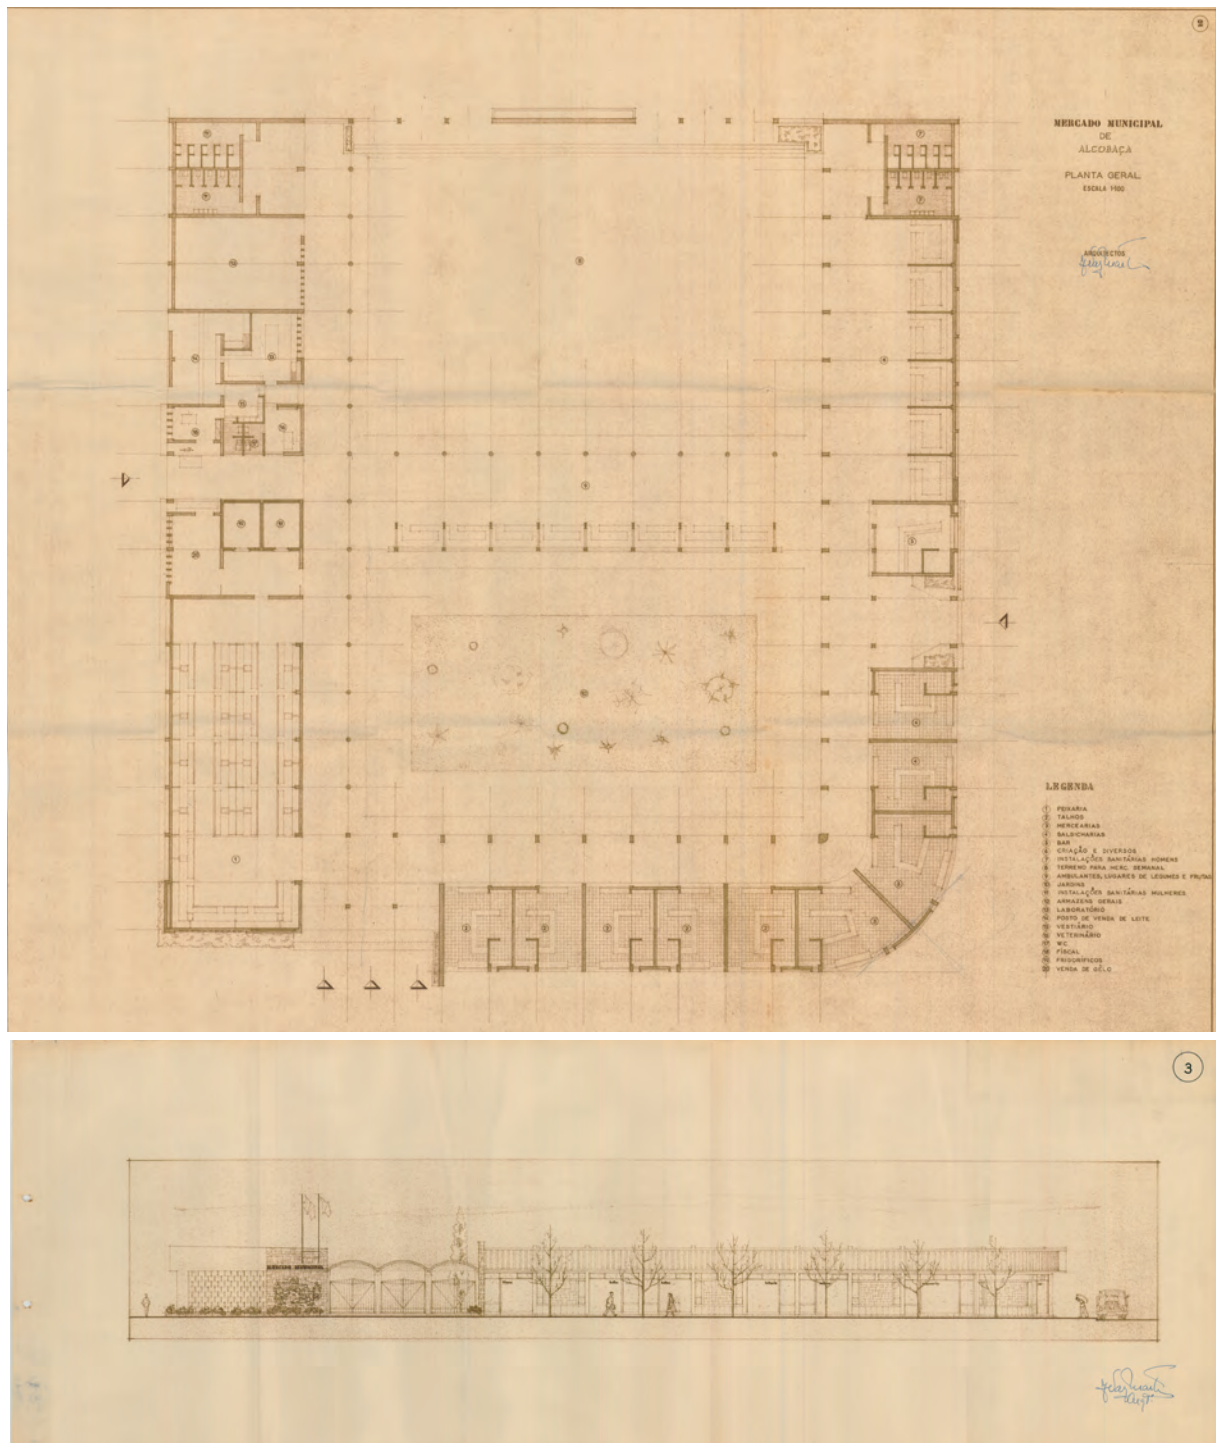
Planta ao Nível da Entrada e Alçado Principal.
